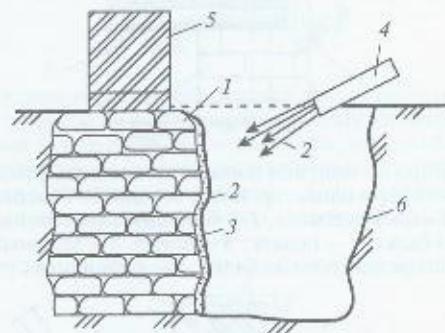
Закрепление бутовой (кирпичной) кладки фундамента торкретбетоном:
